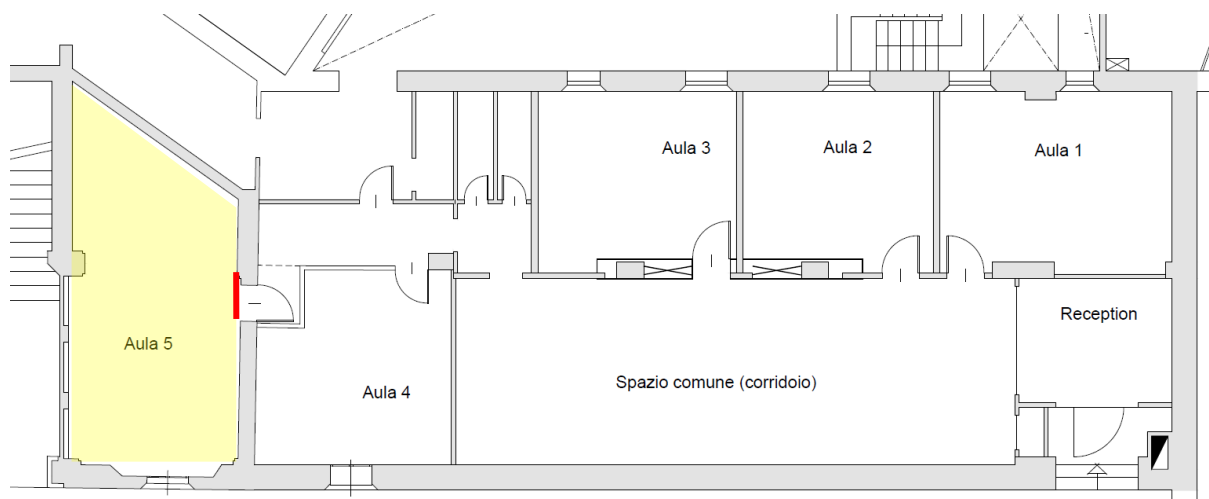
Terzo stralcio - Aula 5 e indicazione delle pareti interessate dagli interventi di isolamento acustico.
